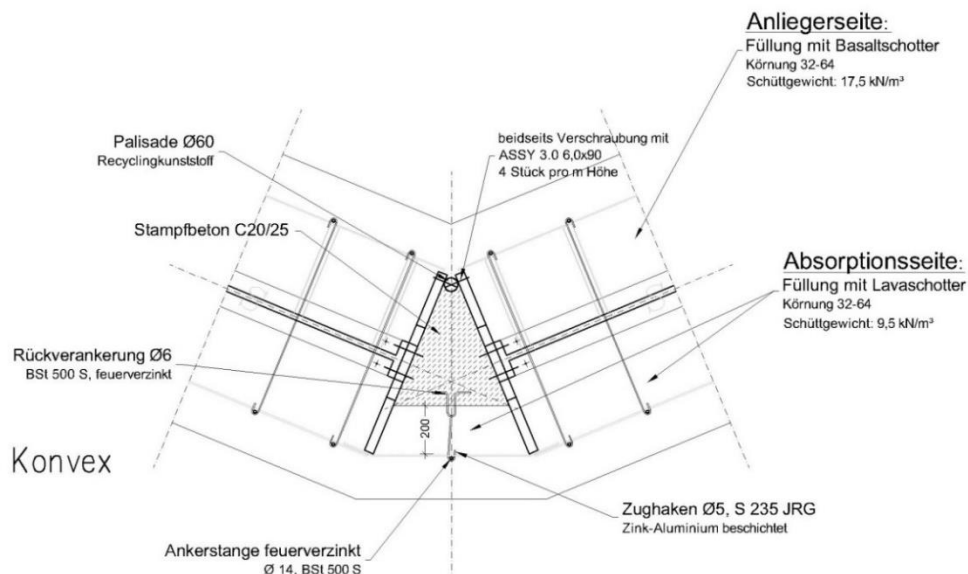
Grundriss 45° Winkel, LSW Basisbreite 0,80 m
